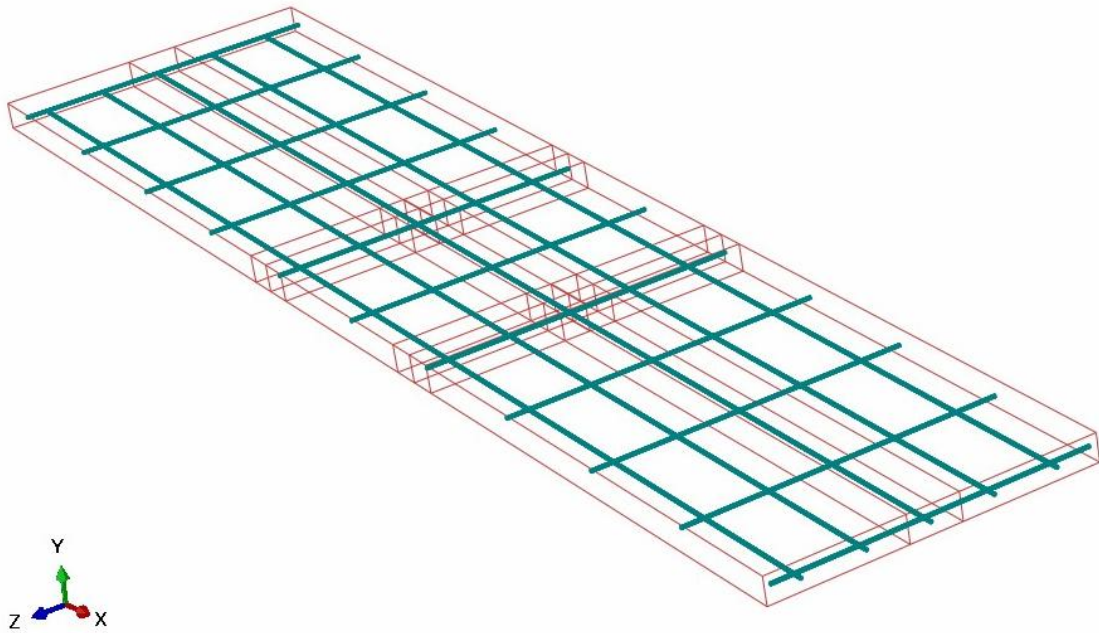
Interação entre armadura passiva e laje de concreto.
